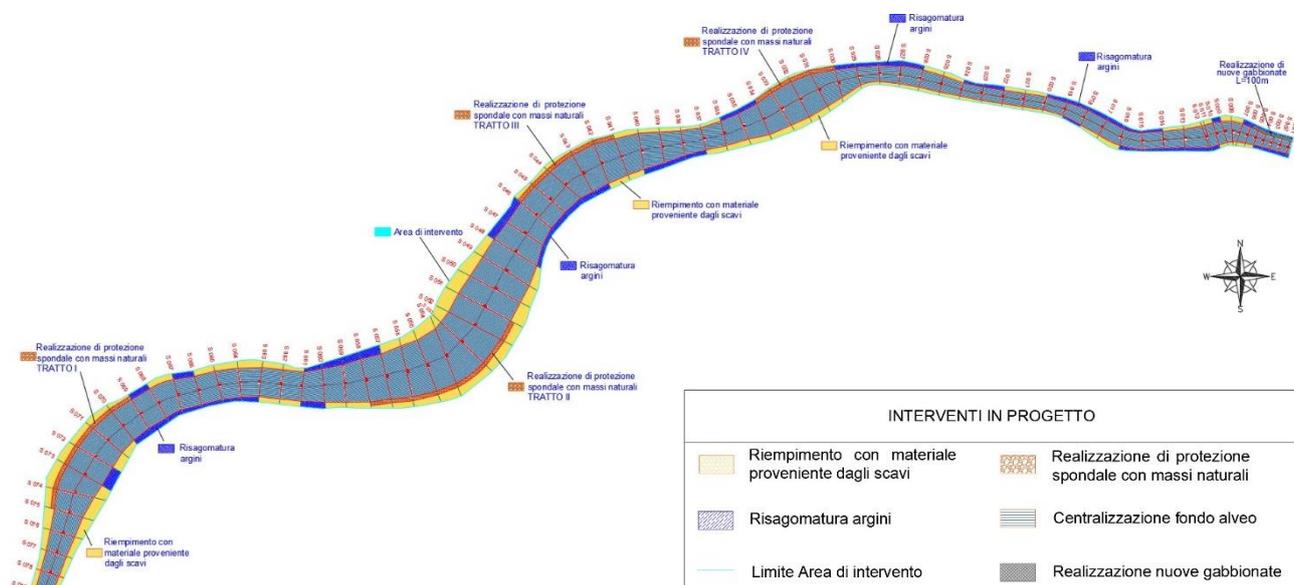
Fiume Lipuda – Planimetria con interventi di progetto
